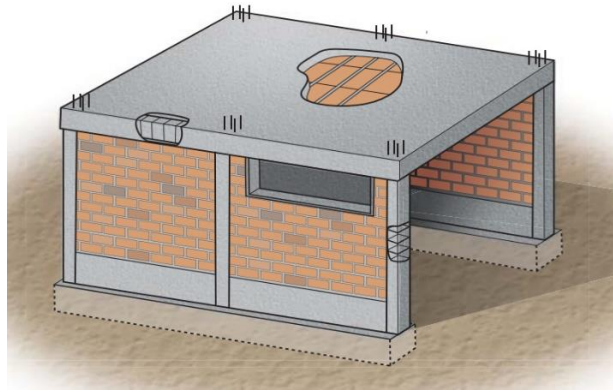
Albañilería confinada (Aceros Arequipa, 2011).
